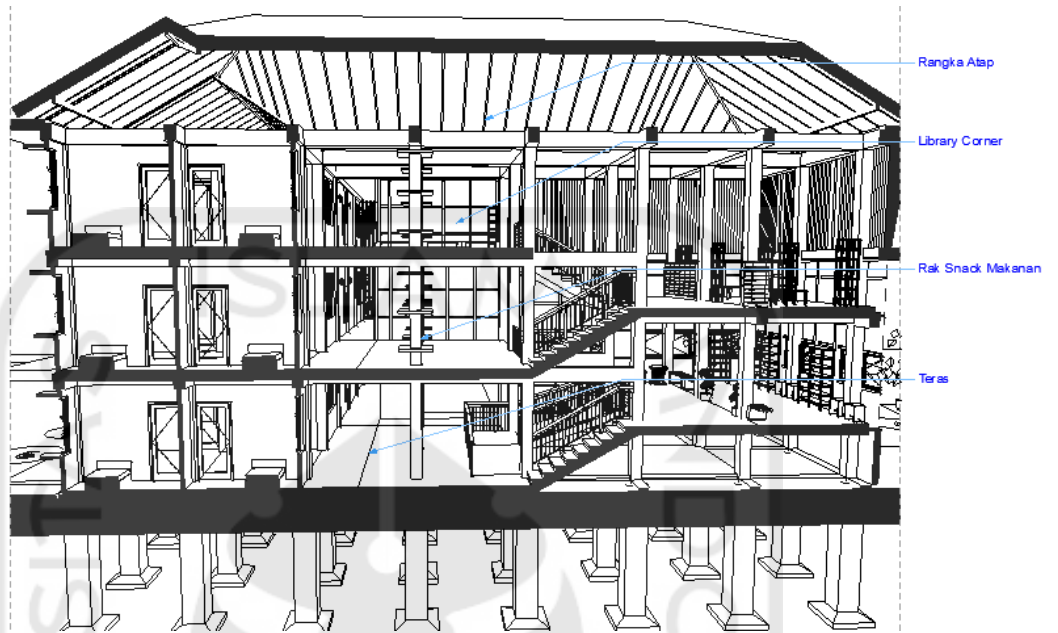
Rancangan Detail Arsitektural Khusus Bangunan
